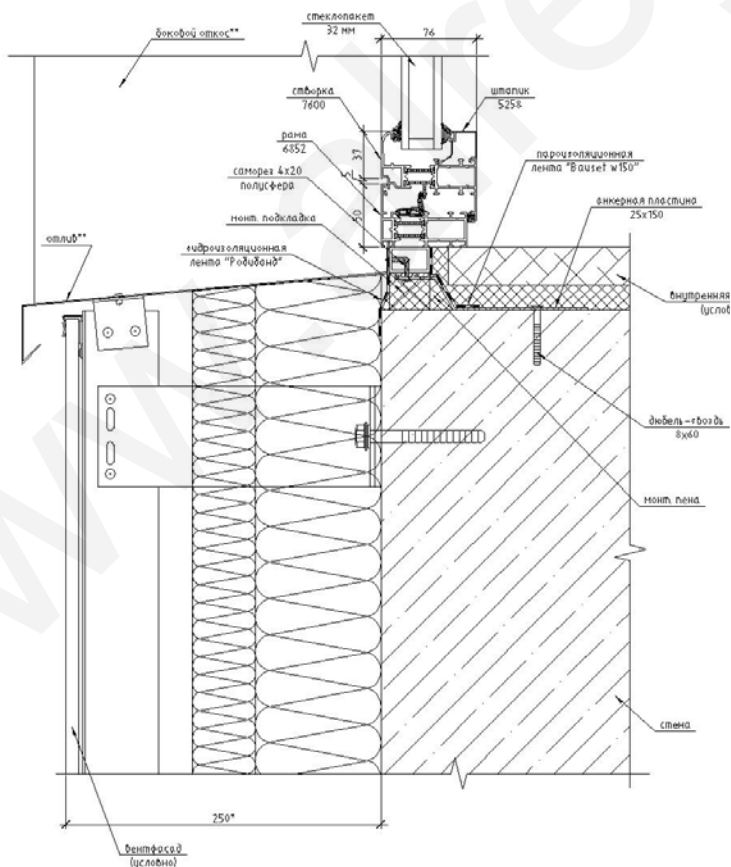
Нижний узел примыкания оконного блока к бетонной стене.
